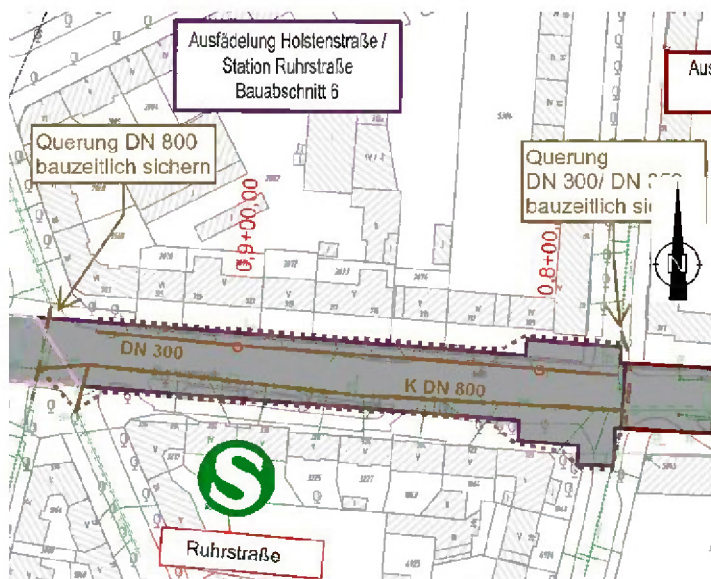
Sielplan Baubereich Station Ruhrstraße, Bauabschnitt 6 (Stand 04.2019)
